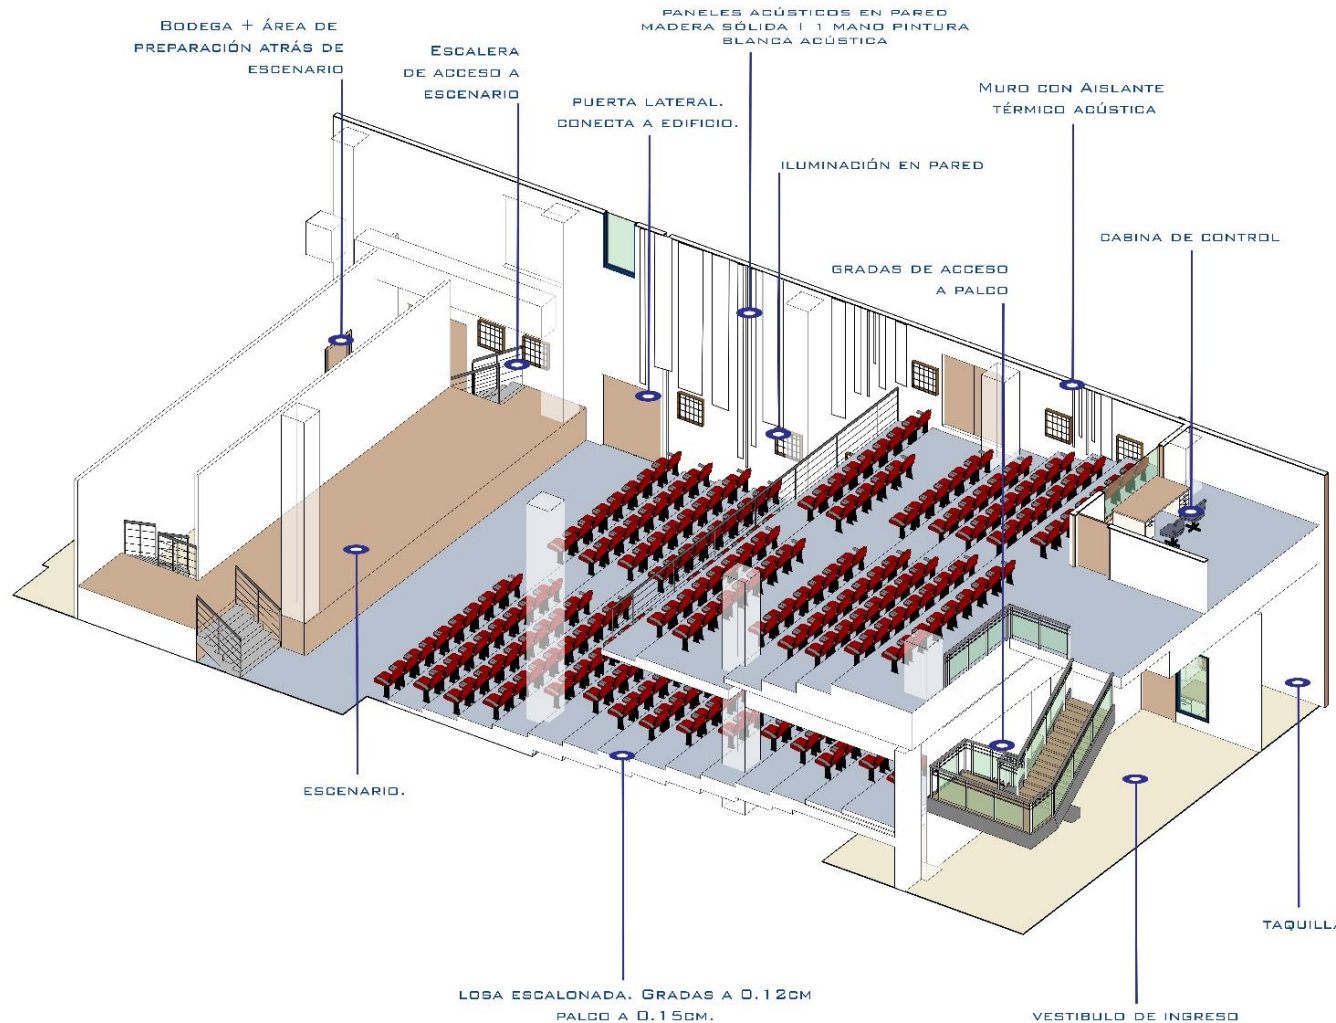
Detalle 3D Auditorium. Fuente: Elaboración propia.
